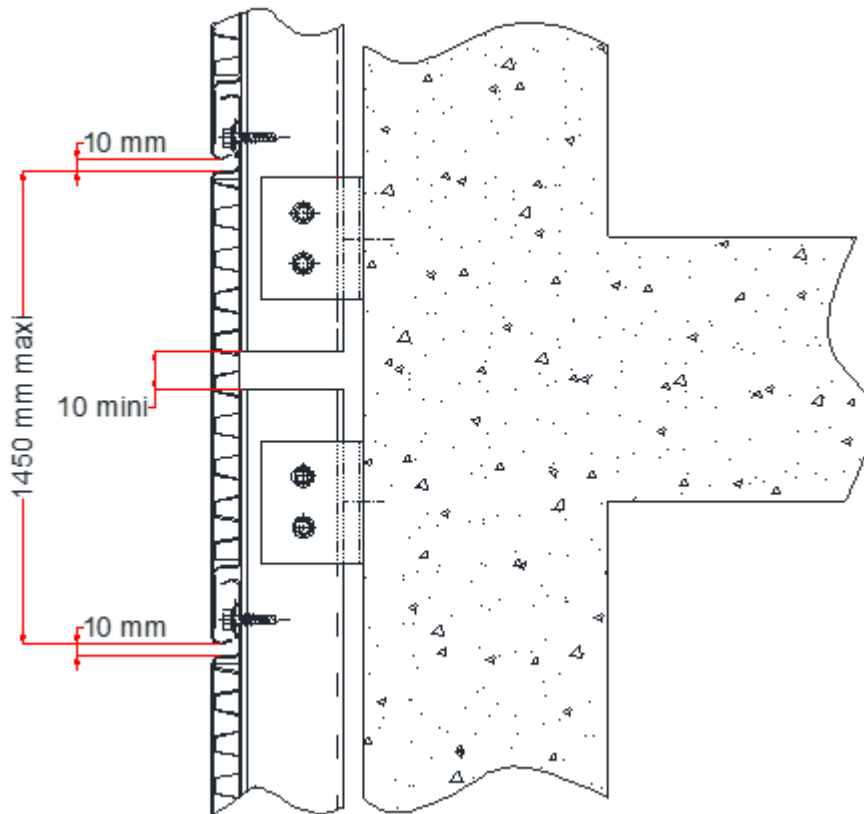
Fractionnement de l'ossature au droit de chaque plancher sur béton
